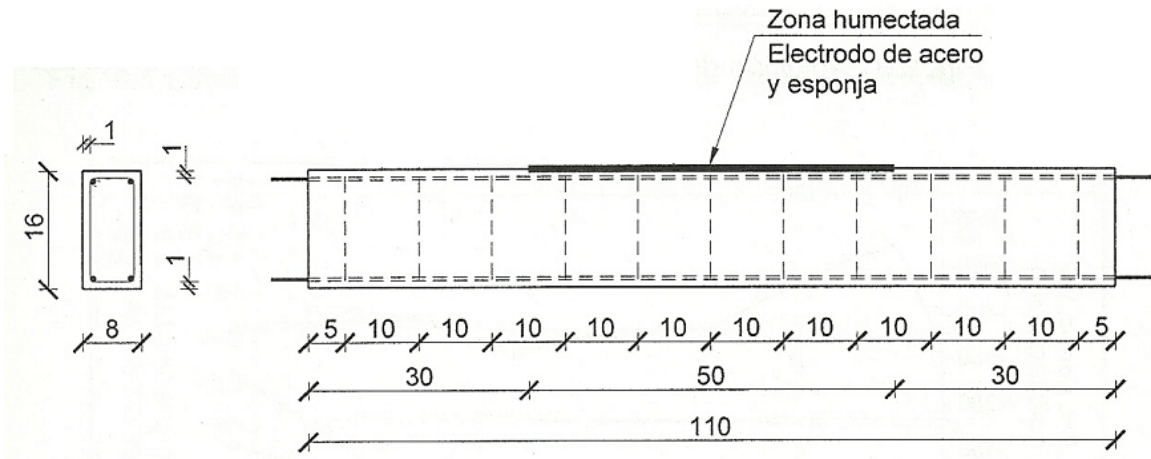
Esquema de las armaduras de las vigas, con dimensiones en cm.
